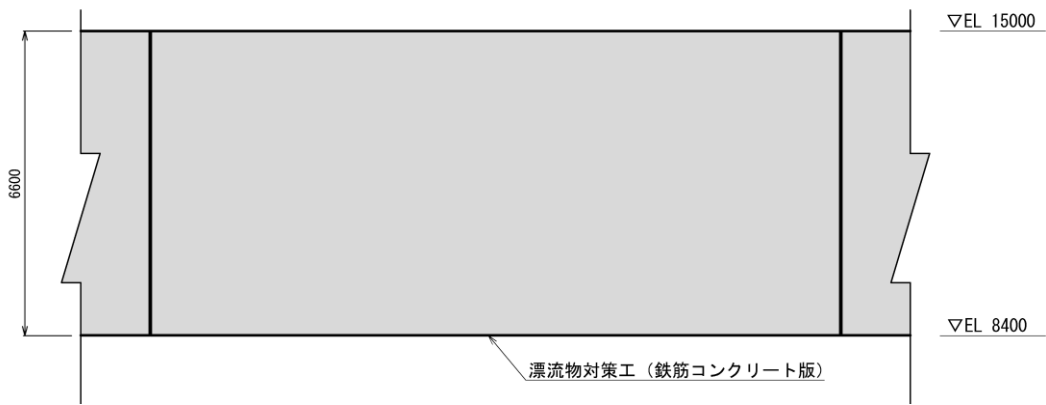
(2) 漂流物対策工（鉄筋コンクリート版）の構造概要図（正面図）
